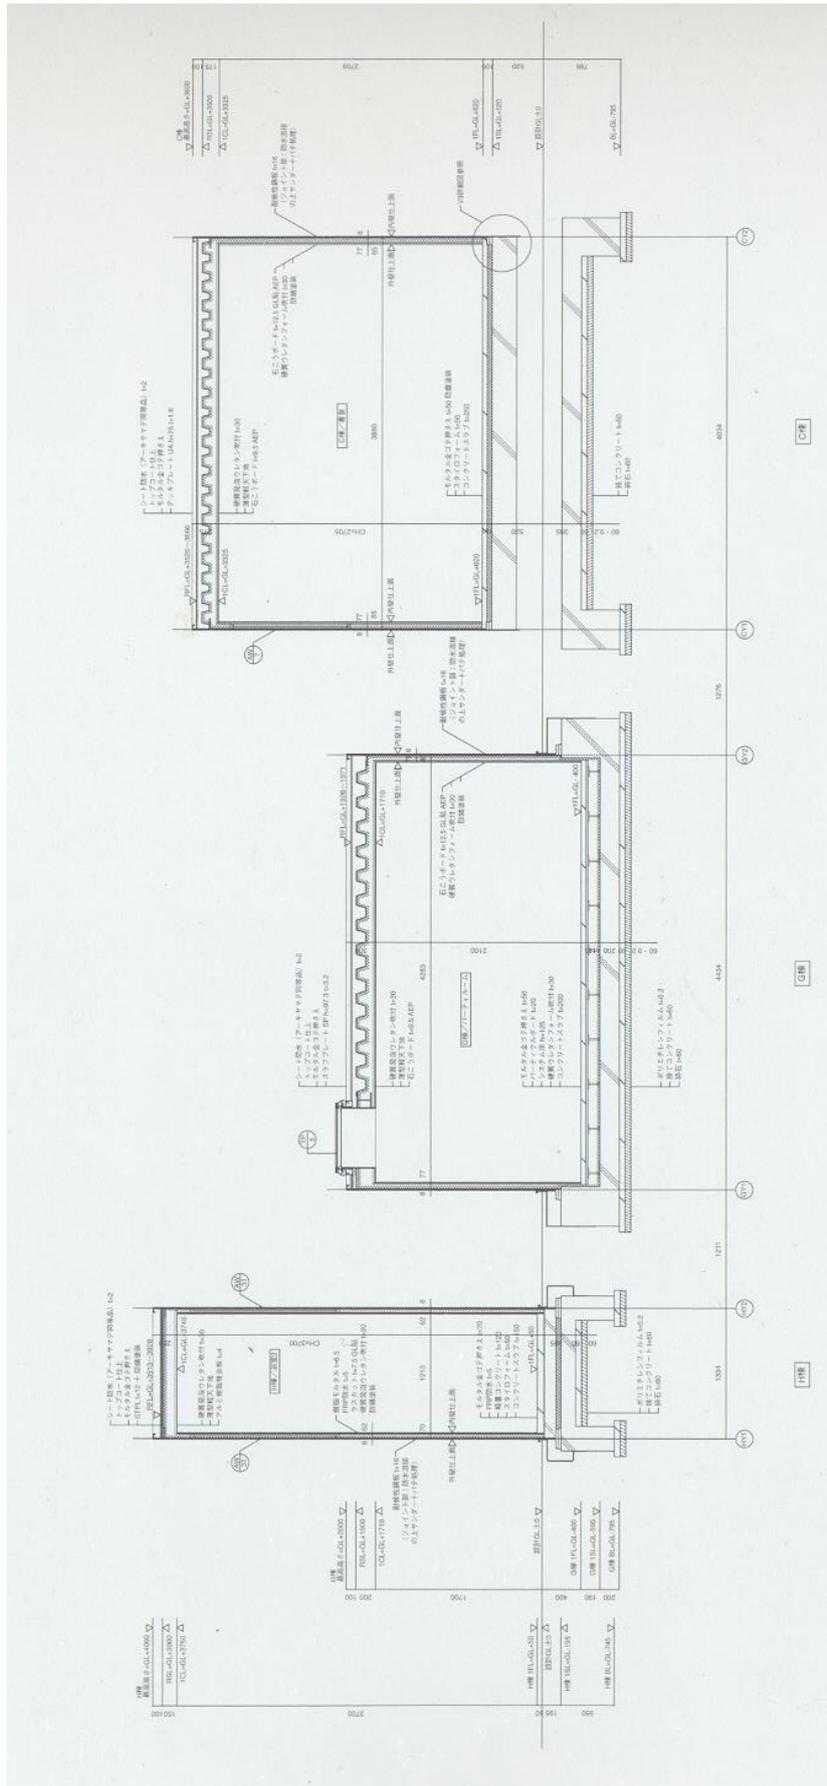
corte transversal moriyana House, Sanna, Tokyo
